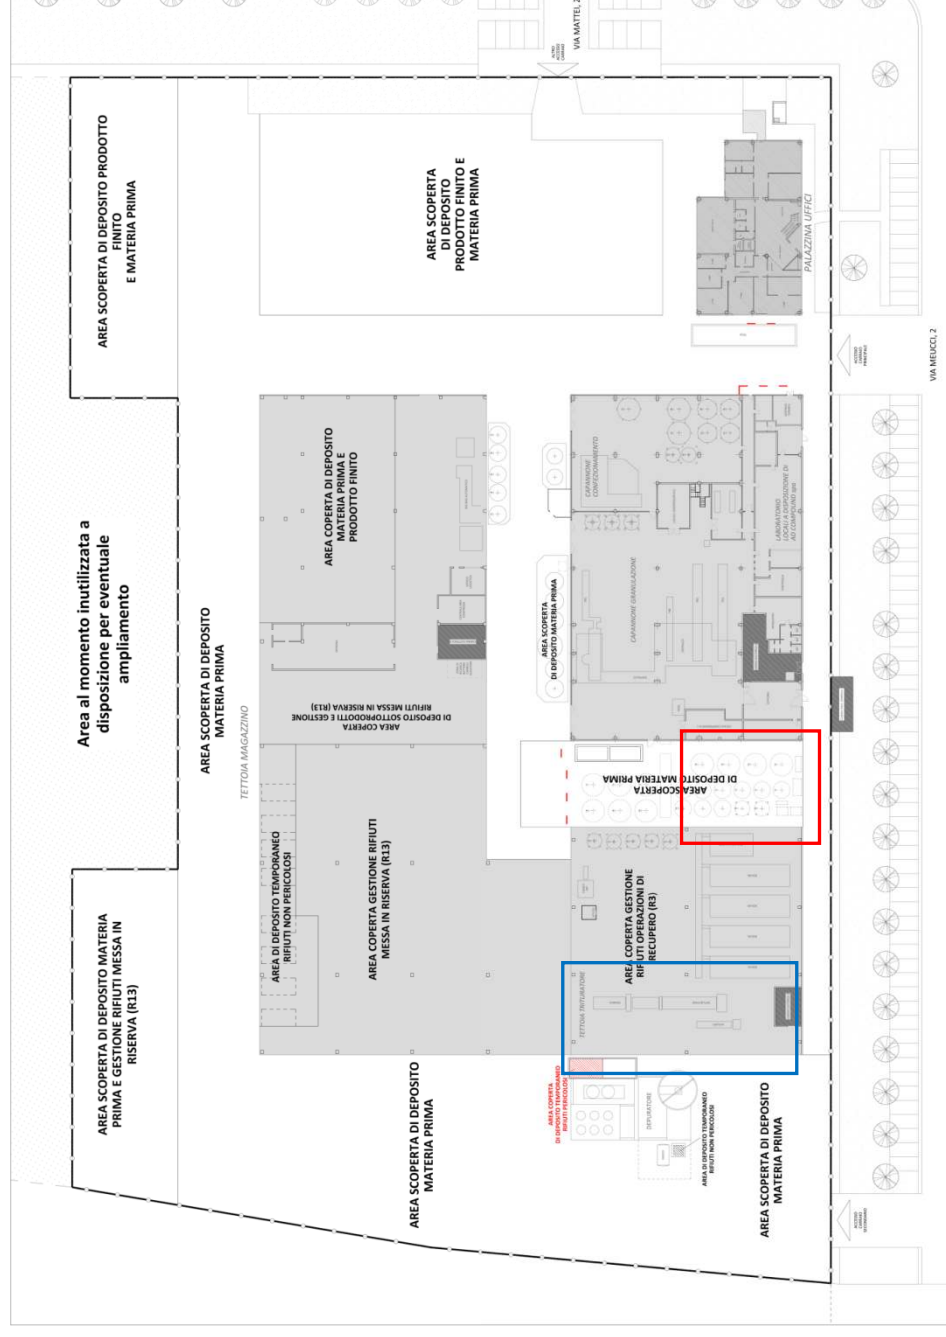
Planimetria generale dell'impianto Plastek di Galliate
